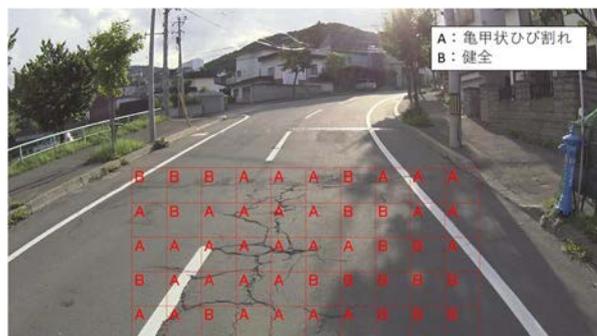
道路舗装に亀甲状ひび割れのある画像
